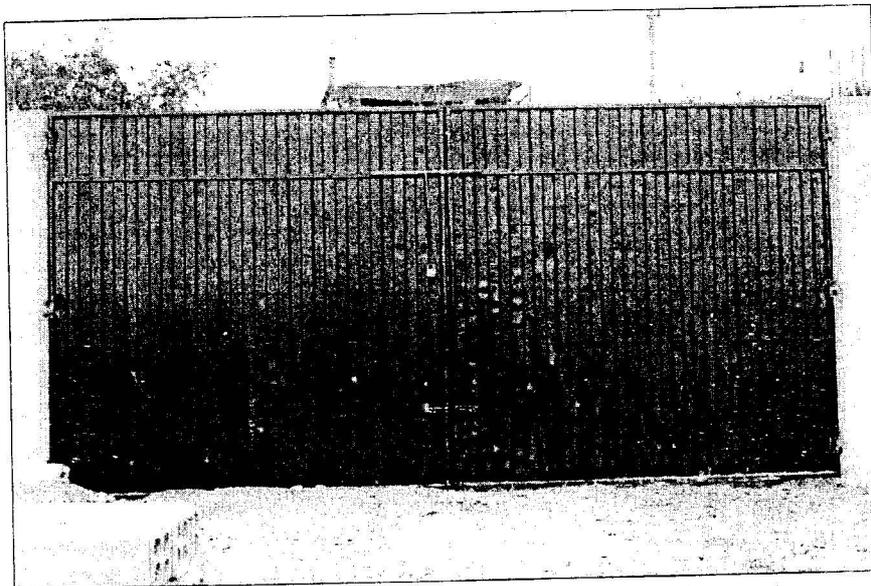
Trabajo terminado de la colocación del Portón Metálico.
